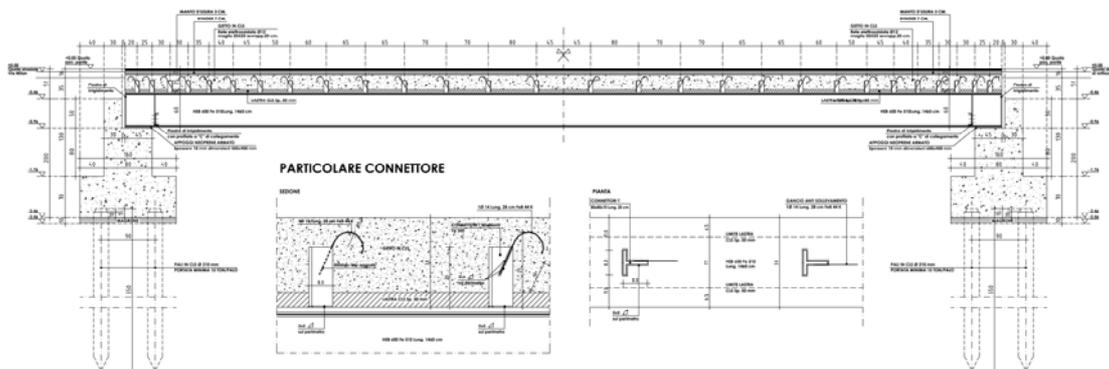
Sezione longitudinale e particolare connettori utilizzati
